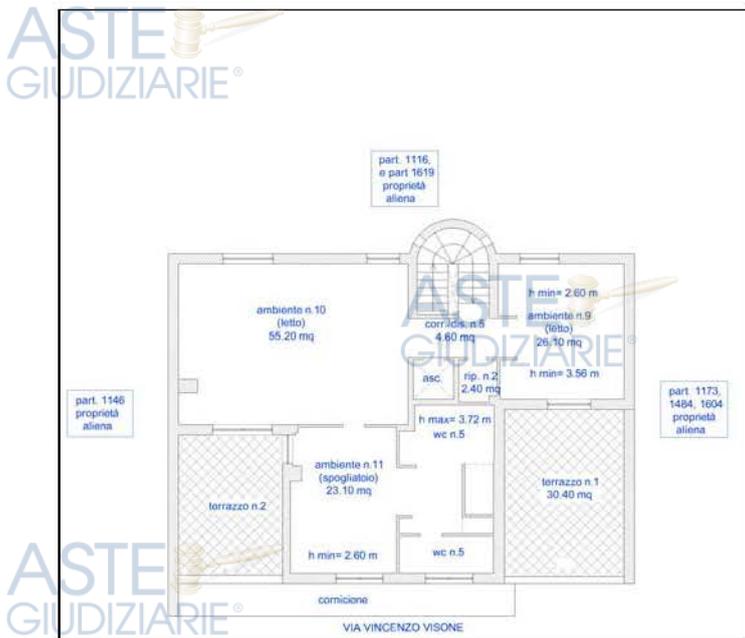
Planimetria stato dei luoghi 2°P del 17/06/2021
